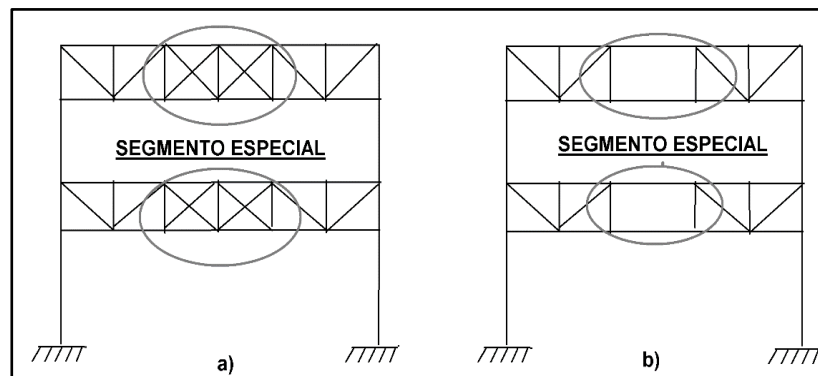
Pórticos con vigas reticuladas. a.) Sección especial reticulada tipo X. b.) Sección especial tipo Vierendeel.
